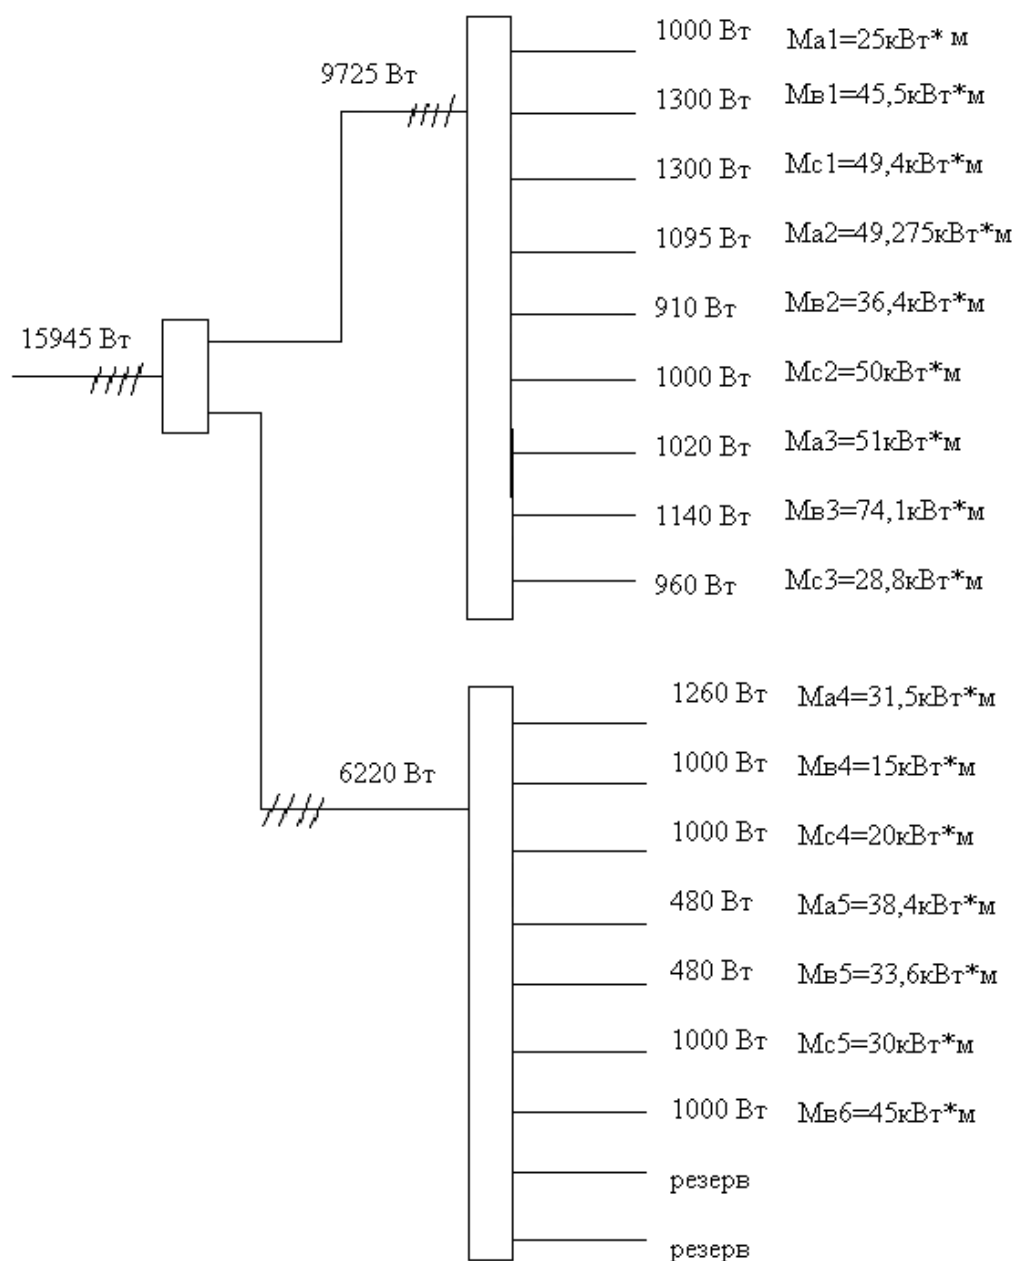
Расчётная схема осветительной сети рабочего освещения
